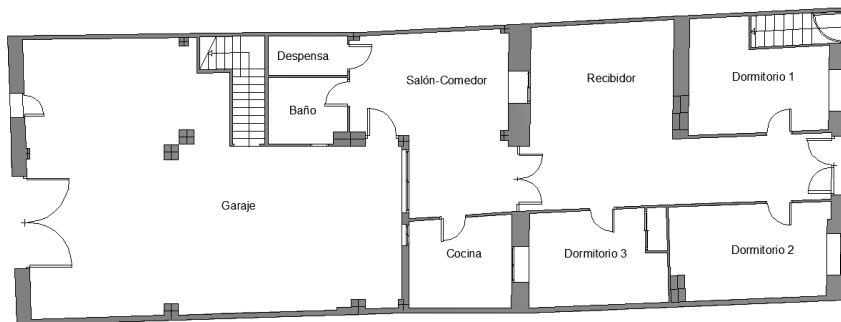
Distribución actual de la vivienda de planta baja. 2014.
